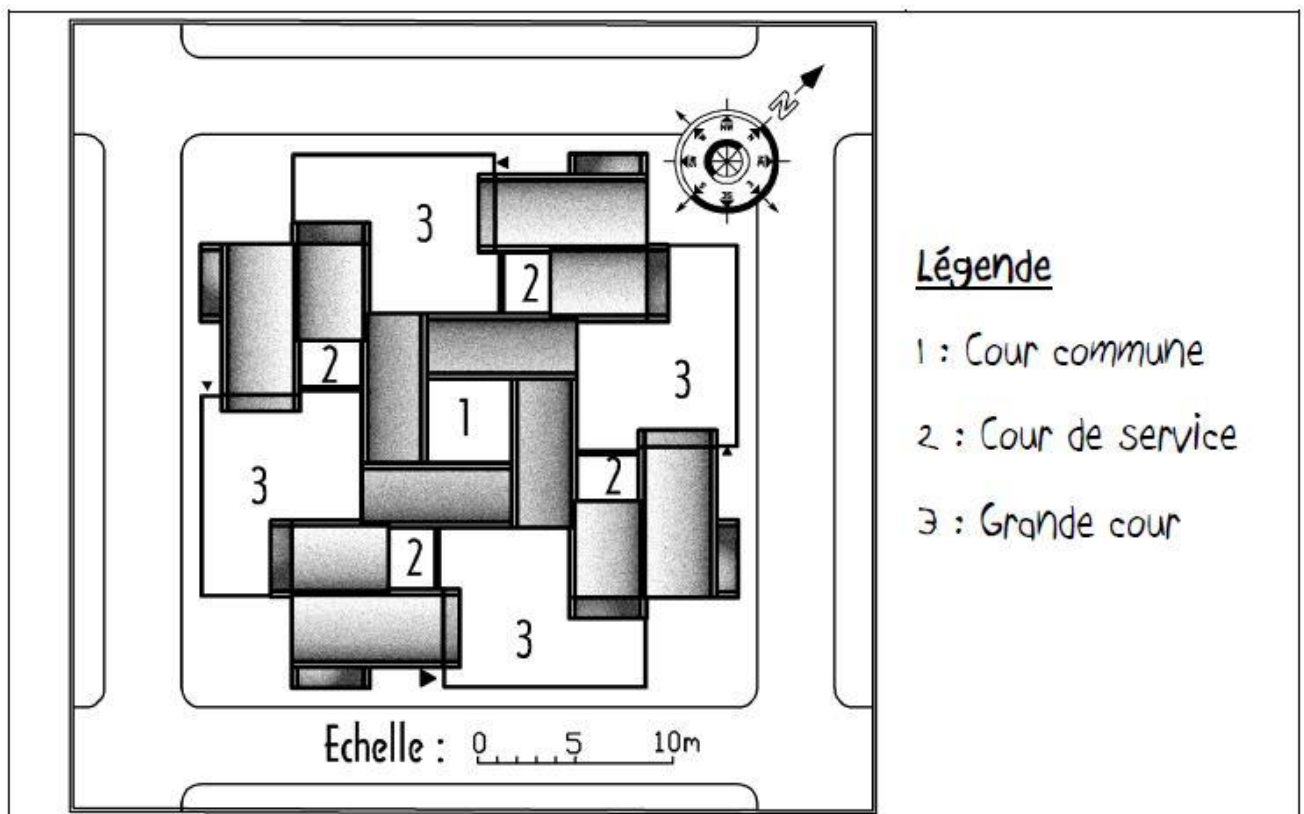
Plan de masse d'un îlot du village de Madher [Kebaili, 2006].
